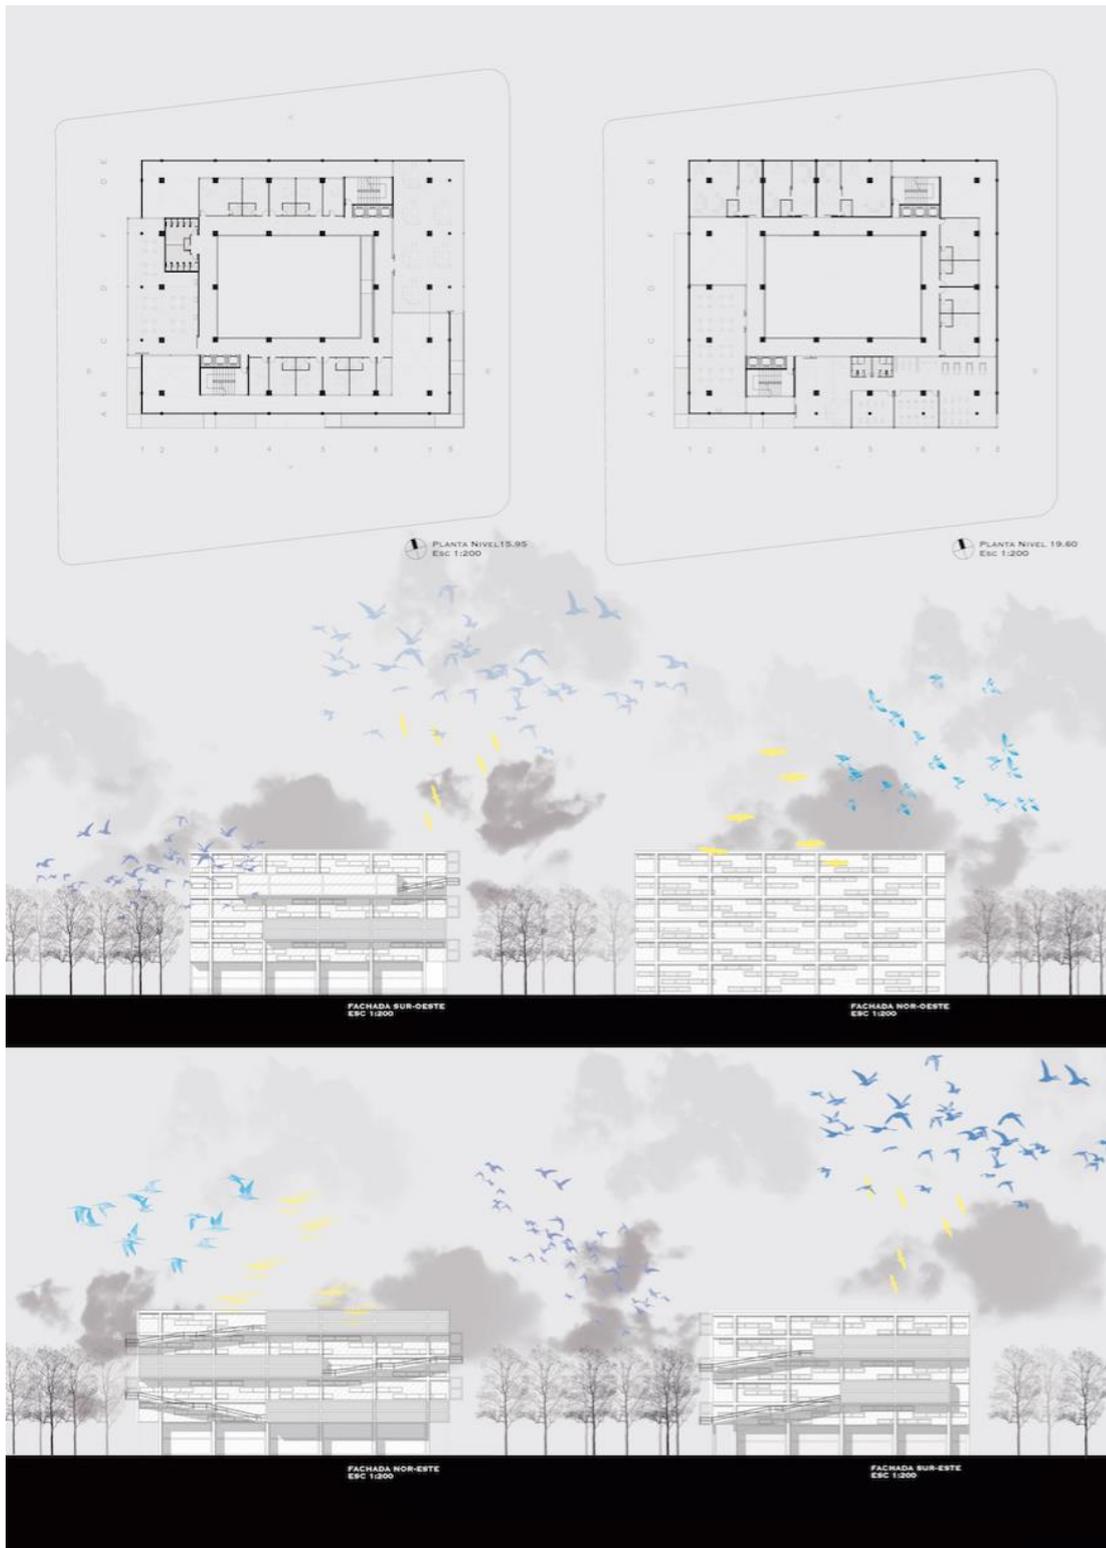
Lámina Fachadas y Plantas Arquitectónicas (Elaboración Propia)
